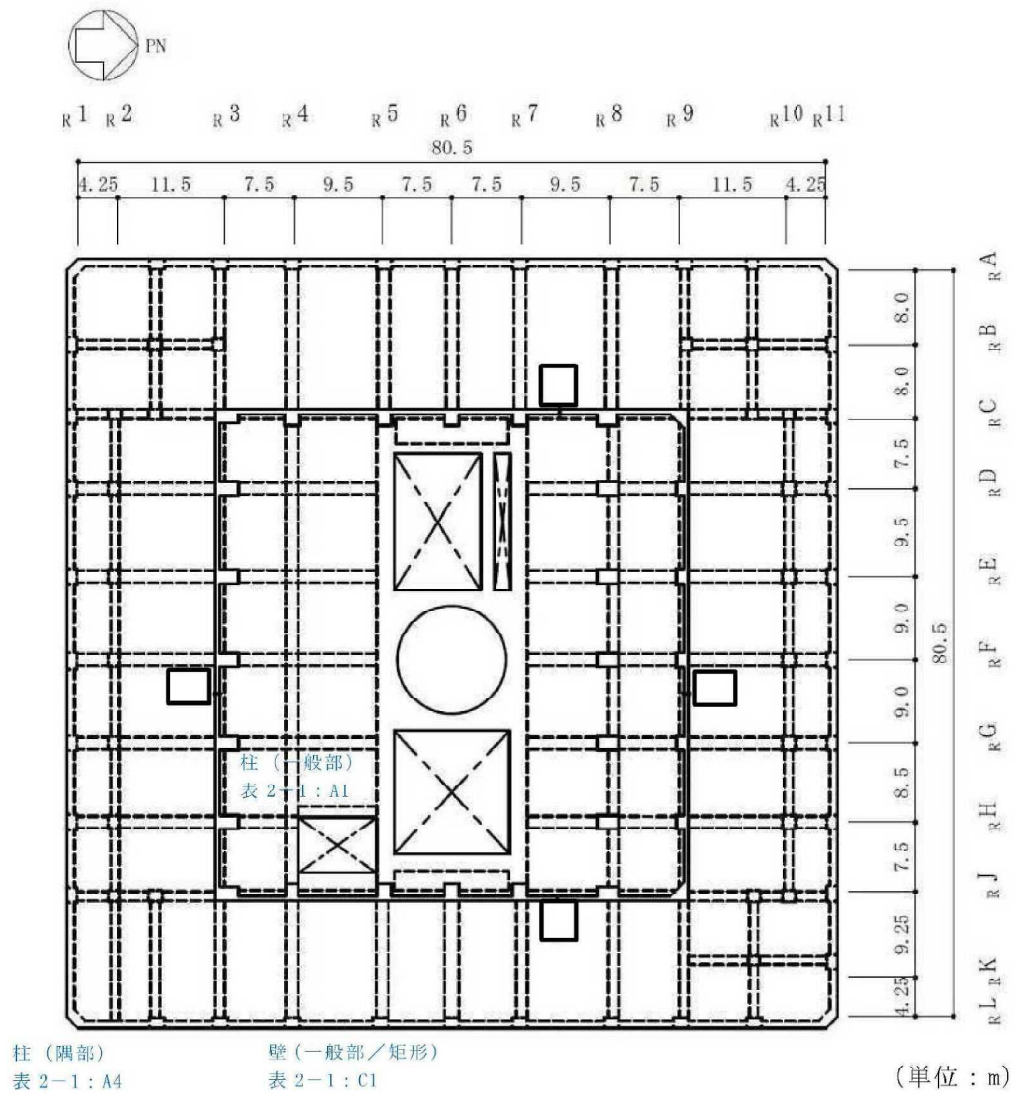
5号機原子炉建屋の概略平面図 (4F, T.M.S.L. 33.0m) (8/9)
